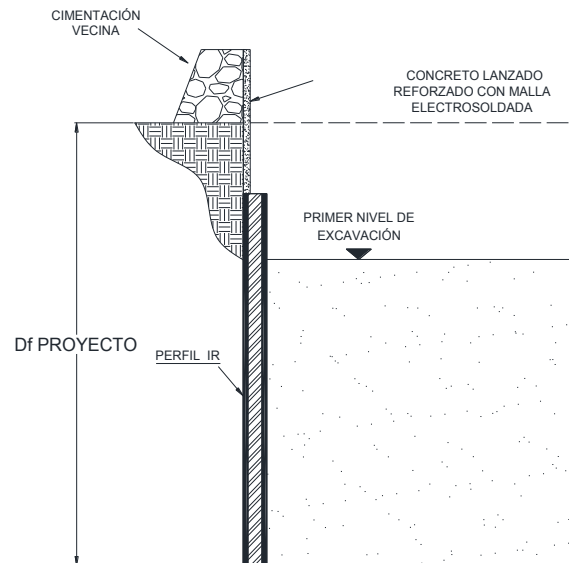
Primer nivel de excavación sin apuntalamiento.
